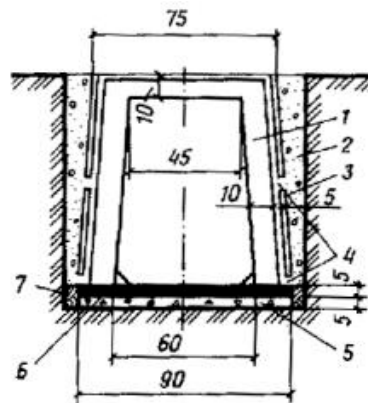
Железобетонный рамный лоток глубиной 1 м
